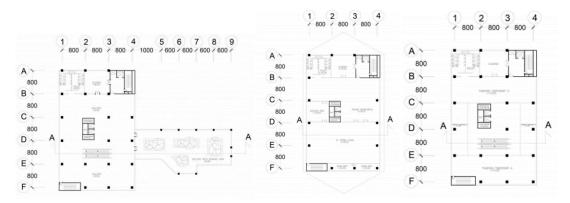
Denah Lantai 1 Sumber: Penulis, 2021
